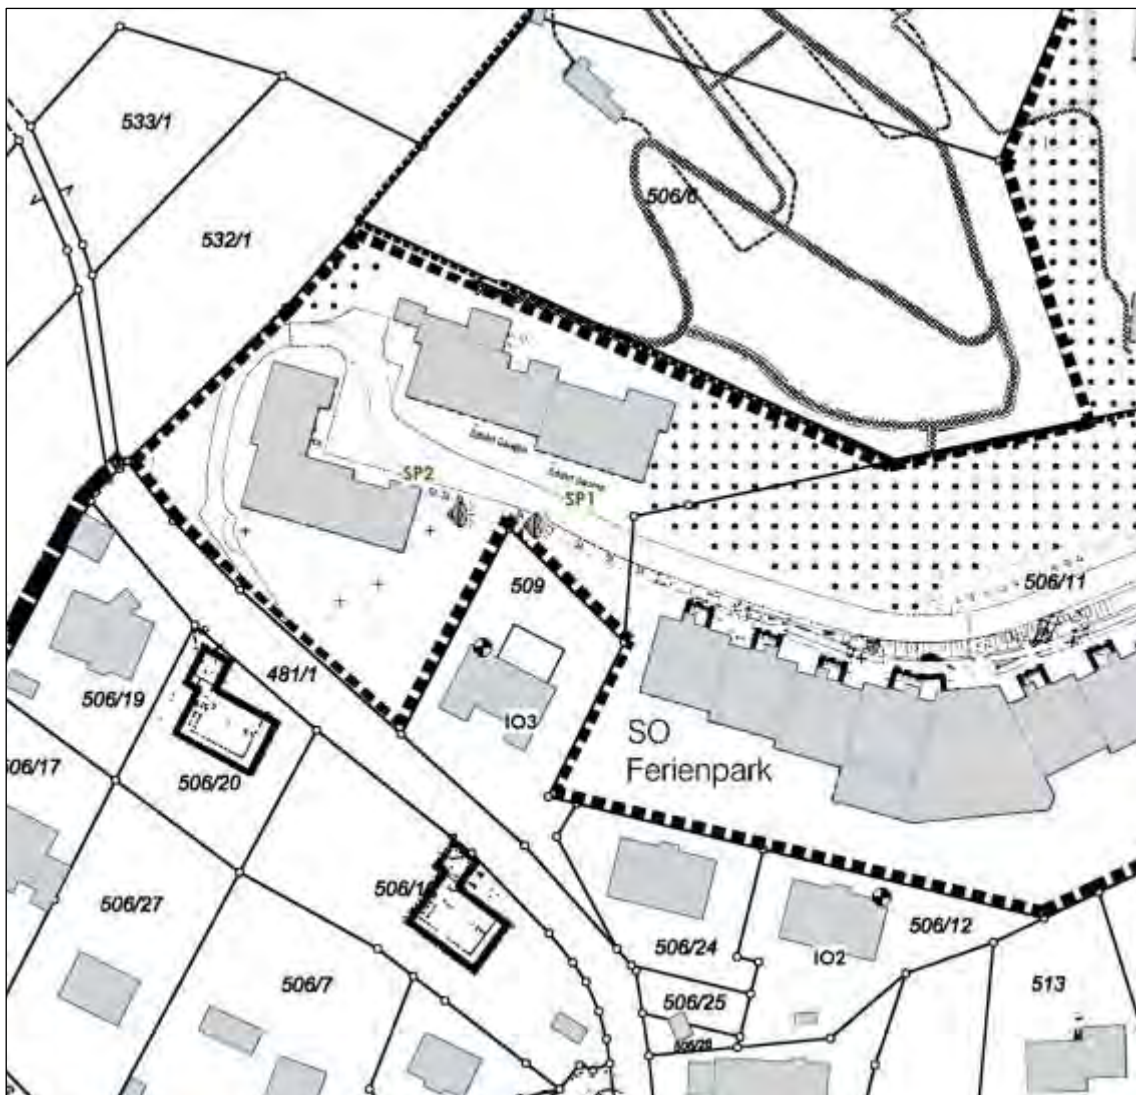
Lageplan mit Eintragung der Punktschallquellen "Spitzenpegel" (SP1/SP2)
